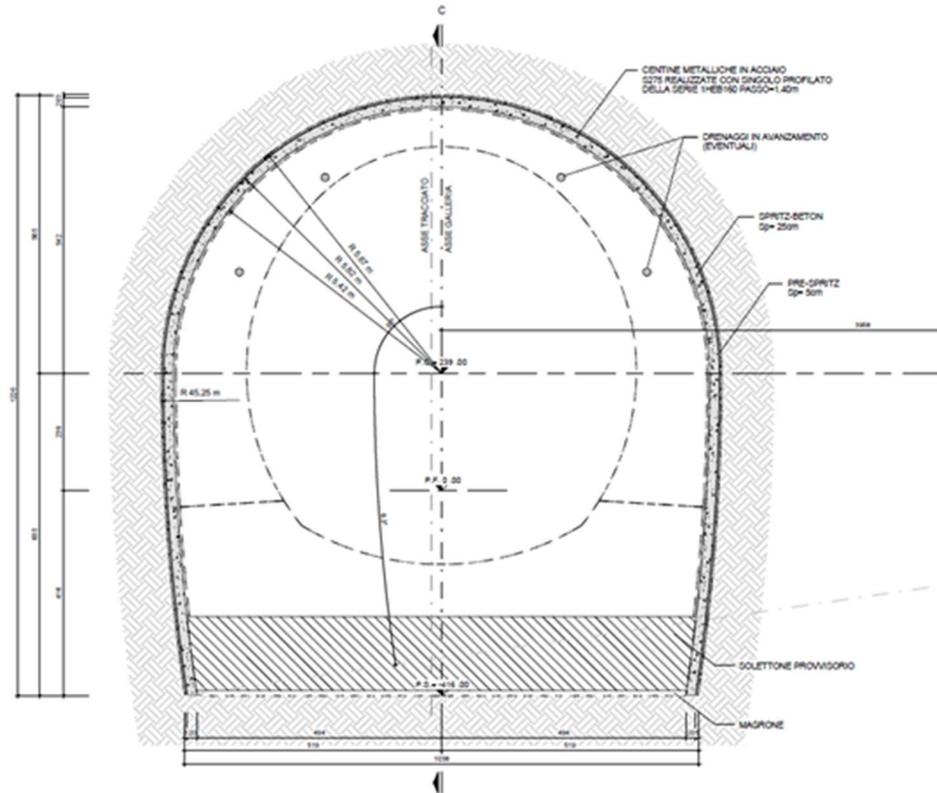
Zona imbocco lato Bari, galleria di linea a doppia canna e singolo binario, sezioni tipo A1-var
